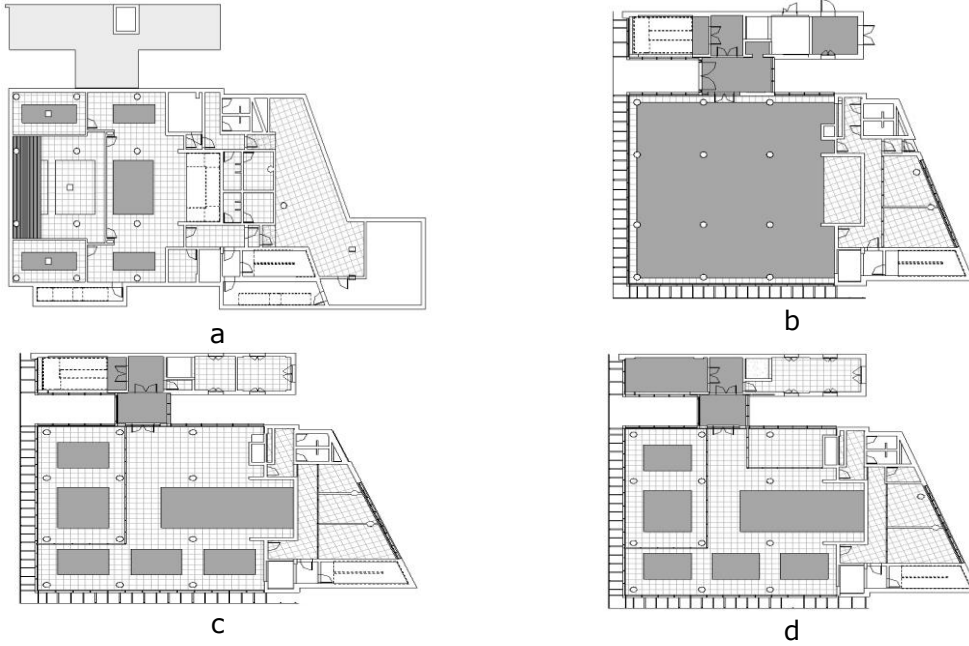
K-Odak Kütüphane Yapısı Kat Planları a) Bodrum Kat Planı b) Zemin Kat Planı c) Normal Kat Planı d) Çatı Katı Planı (Yazarlar tarafından hazırlanmıştır)
